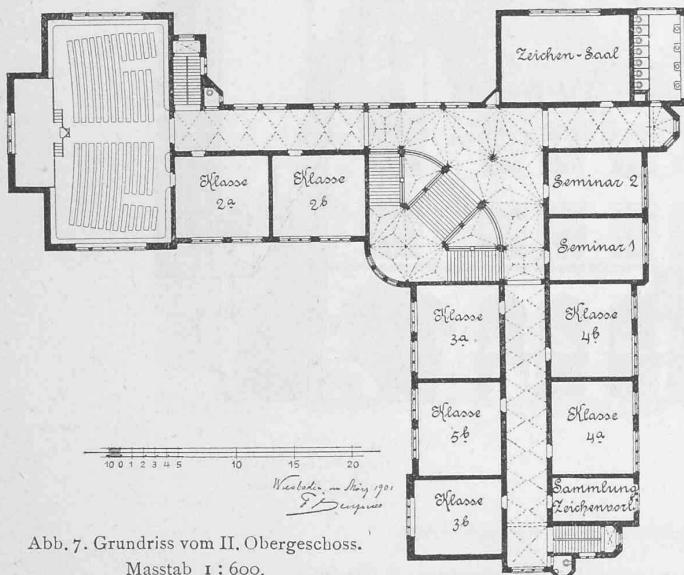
Grundriss vom II. Obergeschoß.
